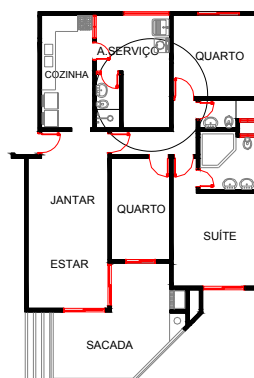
Planta Baixa dos apartamentos 201, 202 e 701 - Estudo de caso E.
